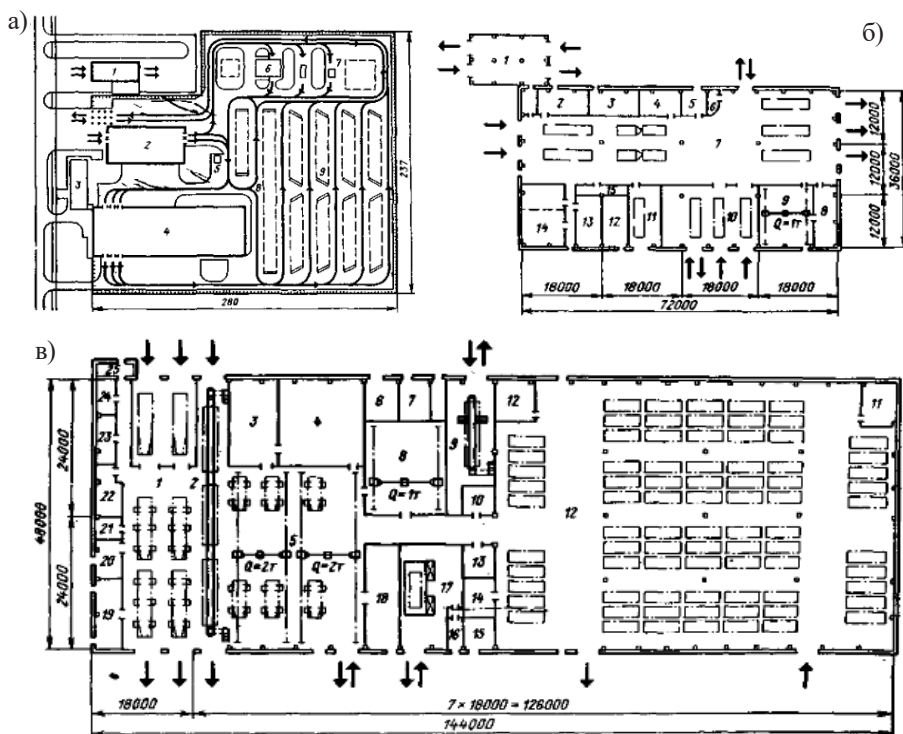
Планировка АТП на 200 грузовых автомобилей с частично закрытой стоянкой: а - генеральный план: 1 - корпус уборочно-моечных работ; 2 - корпус ЕО и ТР; 3 - административно-бытовой корпус; 4 - корпус ТО и ТР; 5 - площадка для хранения баллонов кислорода и ацетилена; 6 - пост слива газа; 7 - пост выпуска и аккумуляирования газа; 8 - стоянка прицепов и полуприцепов; 9 - стоянка автопоездов; 6 - корпус ЕО и ТР: 1 - КПП; 2 - тепловой пункт; 3 - венткамера; 4 - компрессорная; 5 - склад масла; 6 - комната мастера; 7 - посты комплекса работ ЕО; 8 - шиномонтажный участок; 9 - склад шин; 10 - тепловой участок; 11 - деревообрабатывающий и обойный участки; 12 - трансформаторная; 13 - инструментально-раздаточная и промежуточная кладовая; 14 - участок отдела главного механика; 15 - бытовые помещения; в - корпус ТО и ТР: 1 - посты ТО-1 и ТО-2; 2 - посты Д-1; 3 - комплекс подготовки производства; 4 - агрегатно-механический участок; 5 - посты ТР; 6 - трансформаторная; 7 - электрощитовая; 8 - склад запасных частей, агрегатов и материалов; 9 - пост Д-2; 10 - бытовые помещения; 11 - венткамера; 12 - закрытая стоянка автомобилей; 13 - комната мастера; 14 - электрощитовая; 15 - тепловой пункт; 16 - краскоприготовительная; 17 - окрасочный участок; 18 - насосная автоматического пожаротушения; 19 - аккумуляторный участок; 20 - склад масел с насосной; 21 - ремонт газовой системы питания; 22 - ремонт приборов карбюраторной и дизельной систем питания; 23 - электротехнический участок; 24 - тепловой пункт; 25 - переход.
